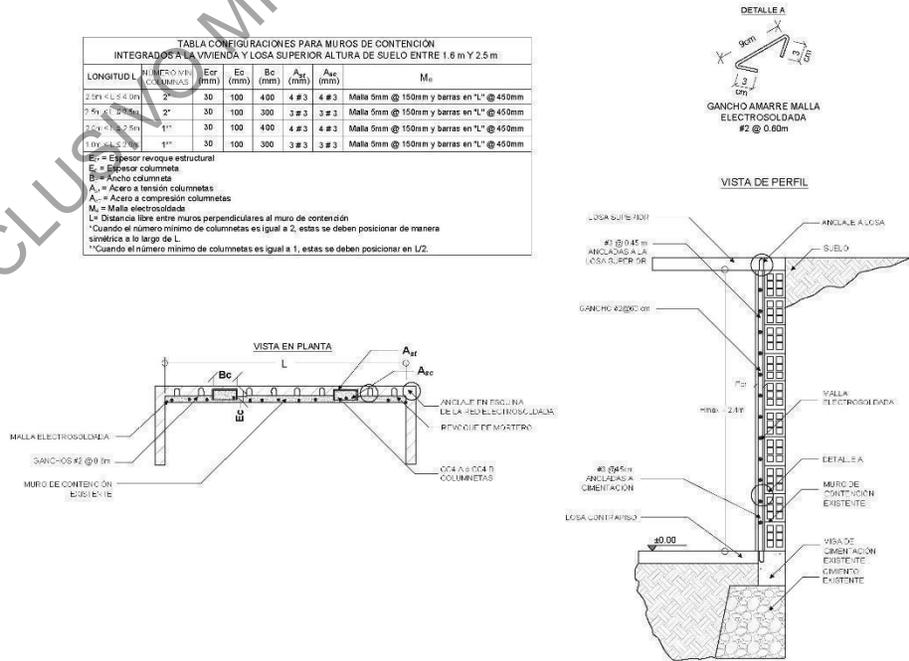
Refuerzo de muro de contención integrado a la vivienda con nueva losa o viga de amarre superior - Altura del suelo hasta 1.8m.
